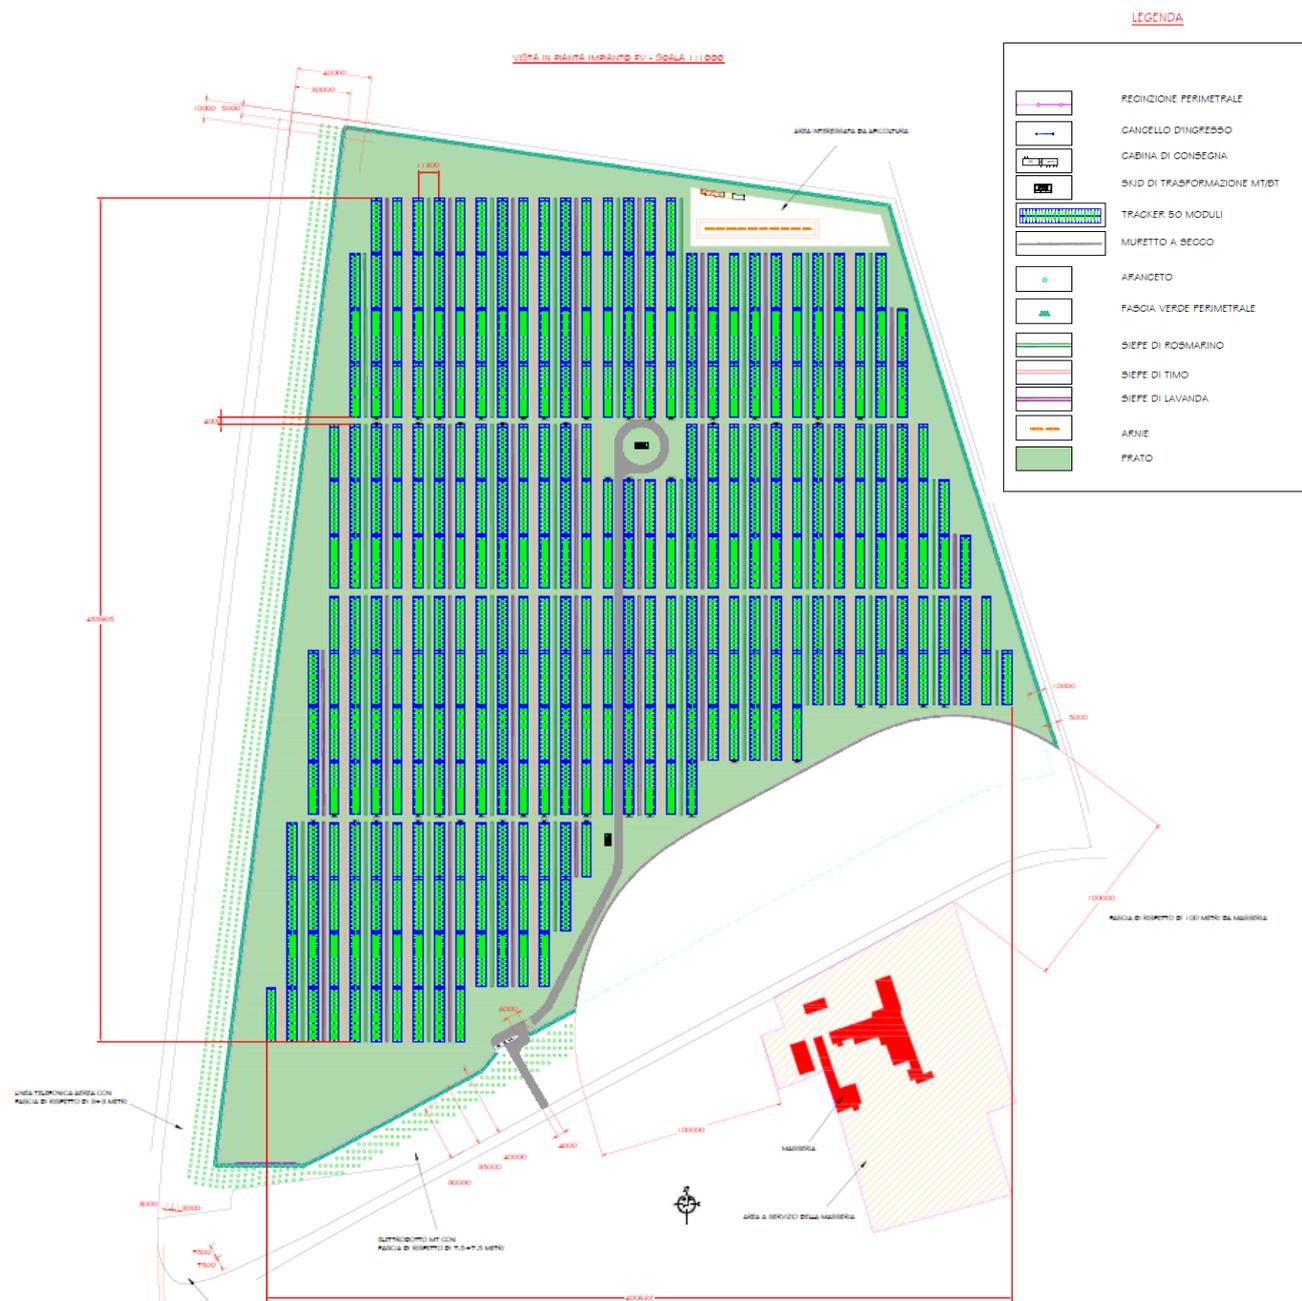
Planimetria d'insieme riportante il layout finale dell'impianto fotovoltaico
